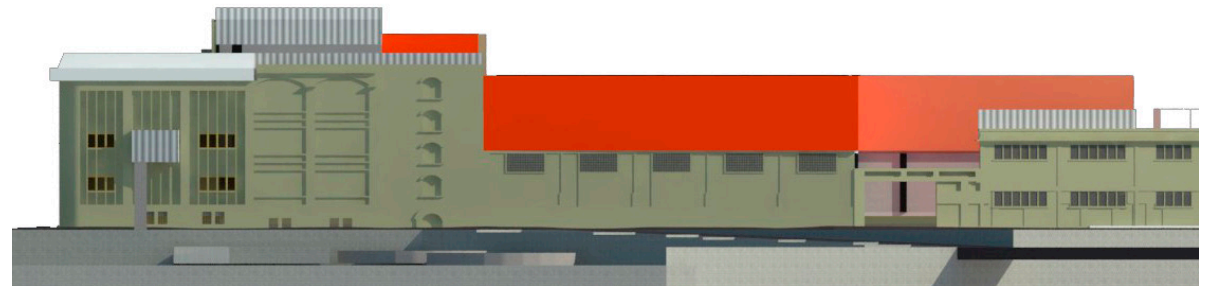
Ubicación de nuevas fachadas a construir en el proyecto.
